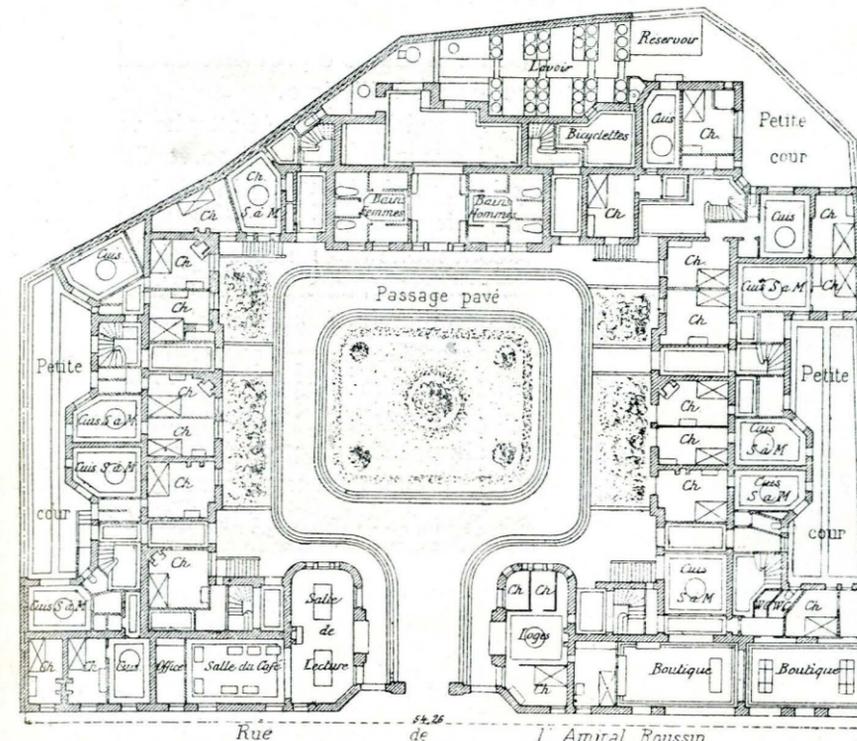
a - Piano terreno - Costruzione di via Amiral-Roussin.
